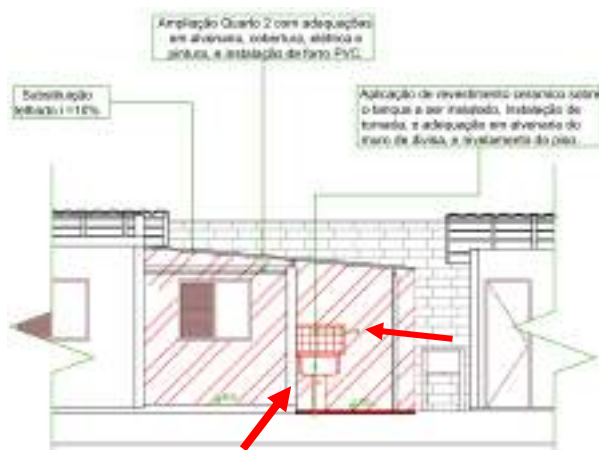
Vista do projeto prevendo a instalação do tanque e ponto de tomada.
